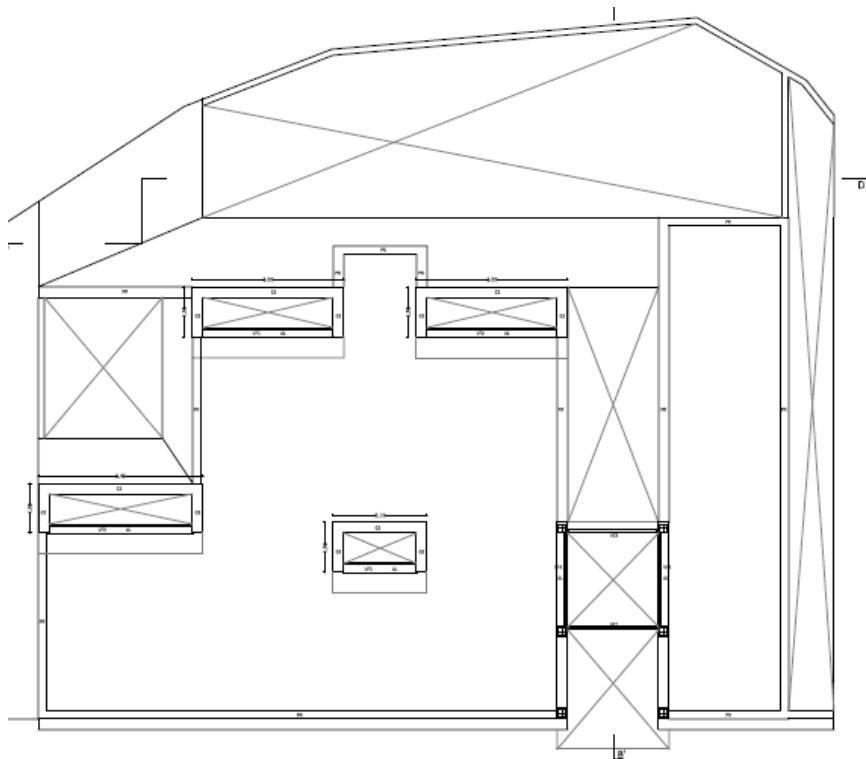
Plano Planta Cubierta de la Escuela Infantil. Fuente: Planimetría Proyecto
